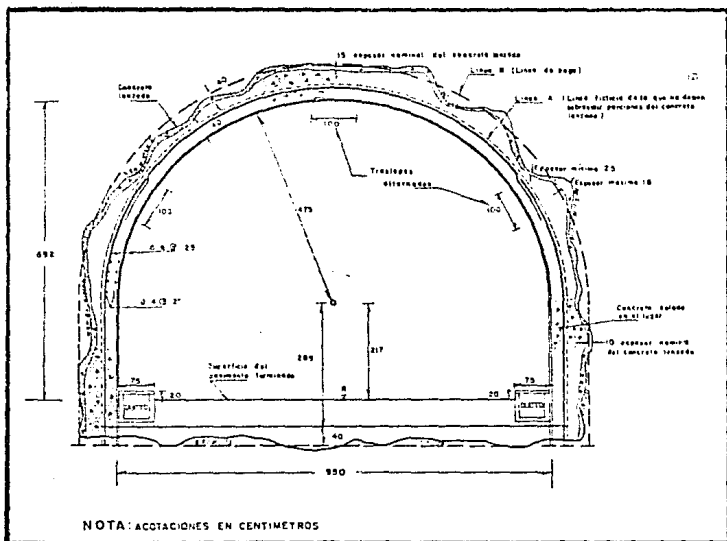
TUNEL DE SECCION IRREGULAR CON CONCRETO LANZADO.
